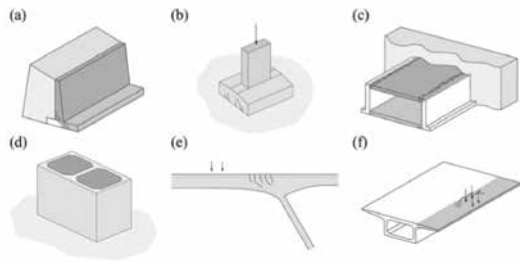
Ejemplos de losas en una dirección y elementos similares sin estribos: (a) muro de contención, (b) cimentación, (c) túnel de corte y recubrimiento, (d) silo, (e) región trapezoidal de apoyo de un puente de pórtico y losa y (f) losa de tablero de un puente con vigas cajón.
